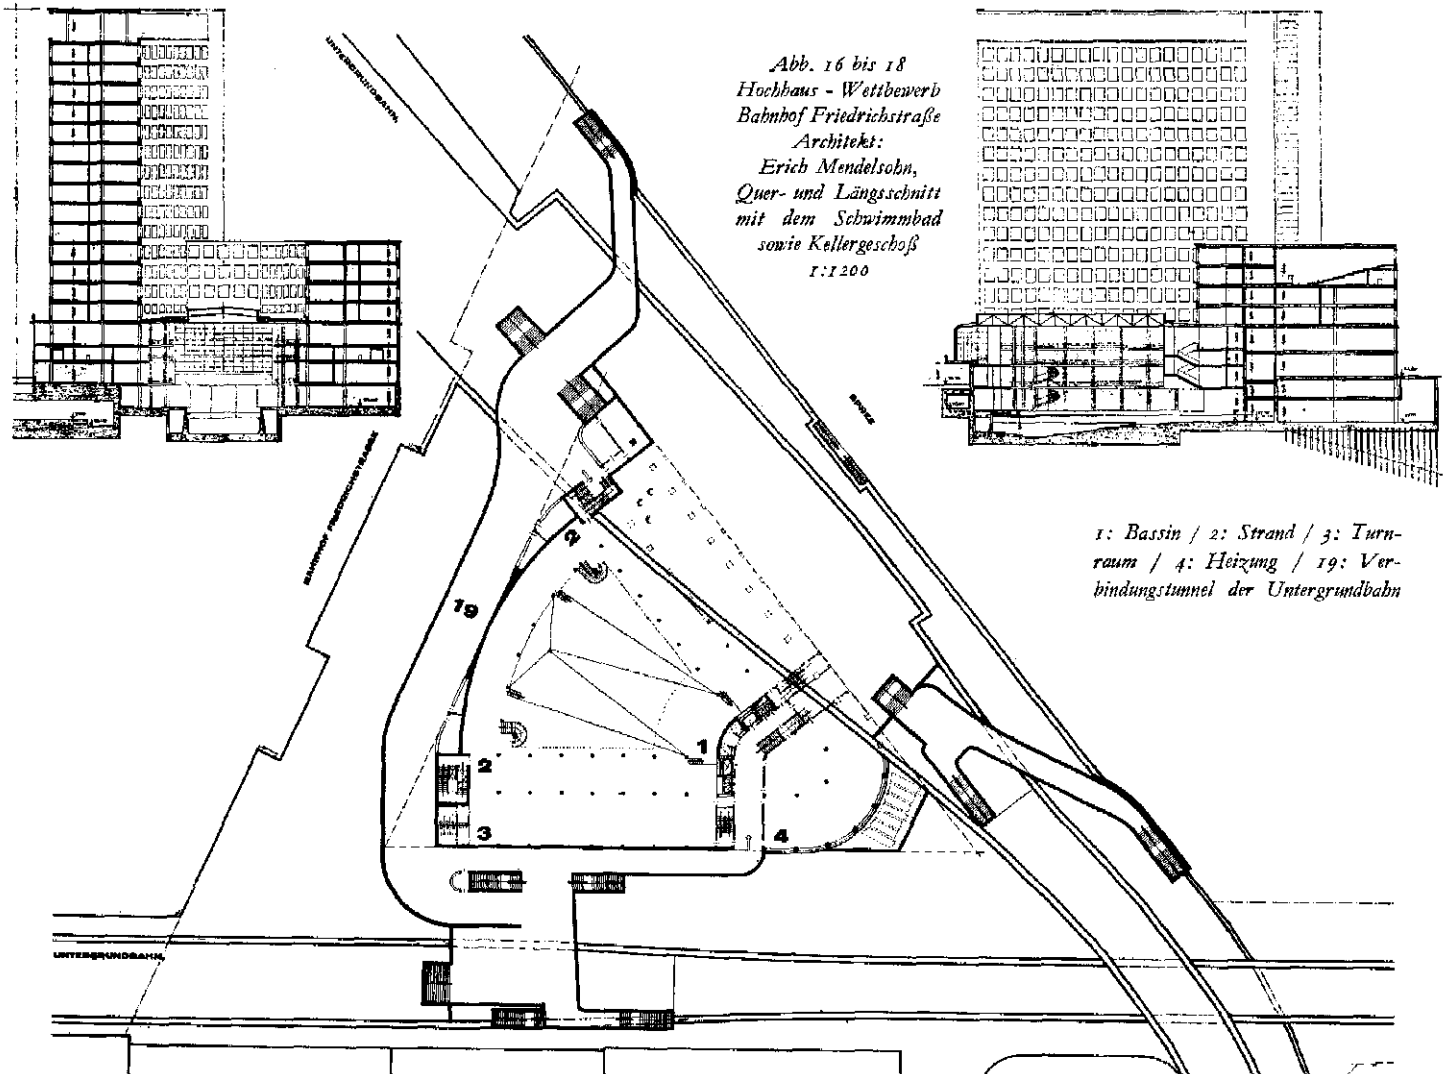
bis 18 Hochhaus - Wettbewerb Bahnhof Friedrichstraße Architekt: Erich Mendelsohn, Quer- und Längsschnitt mit dem Schwimmbad sowie Kellergeschoß 1:1200
